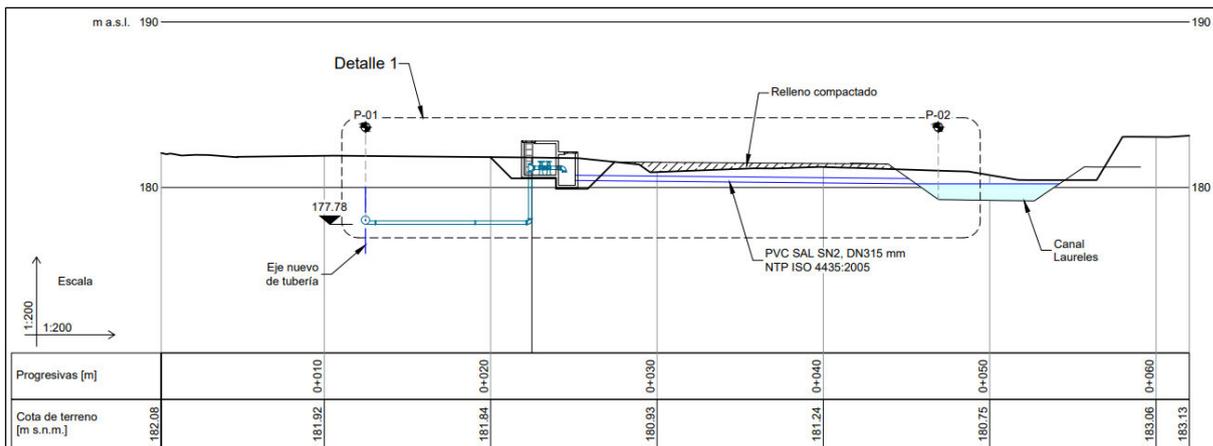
Esquema del replanteo de la ubicación en planta y perfil de la VD-2.
